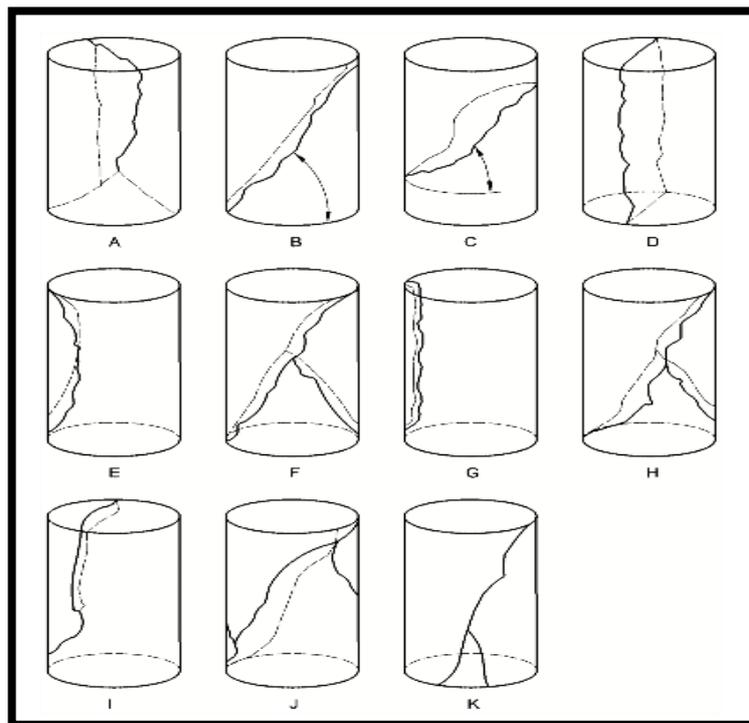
Exemples de ruptures incorrectes d'éprouvettes cylindriques.
